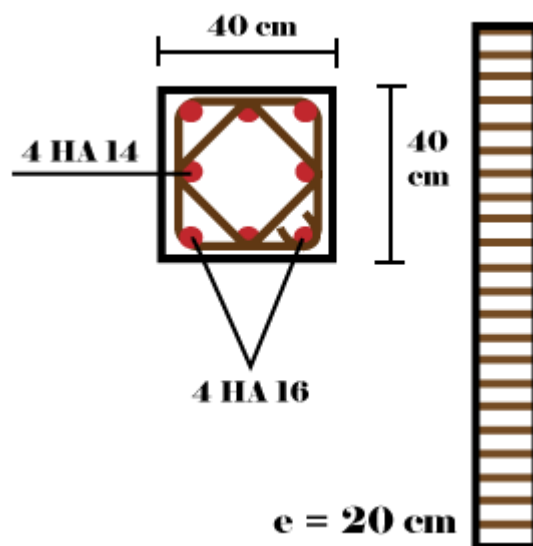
schéma de ferrailage des poteaux des étages courant
